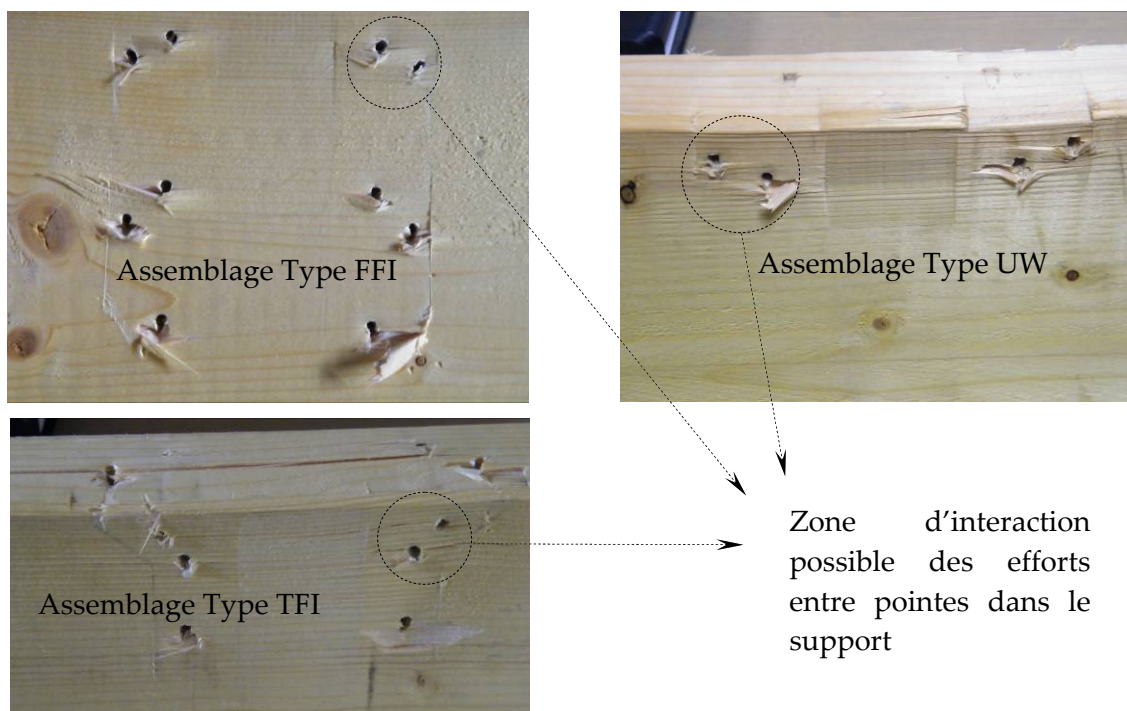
Impact de l'implantation des pointes sur les poutres supports d'ancrage après chargement conduisant à la rupture.
